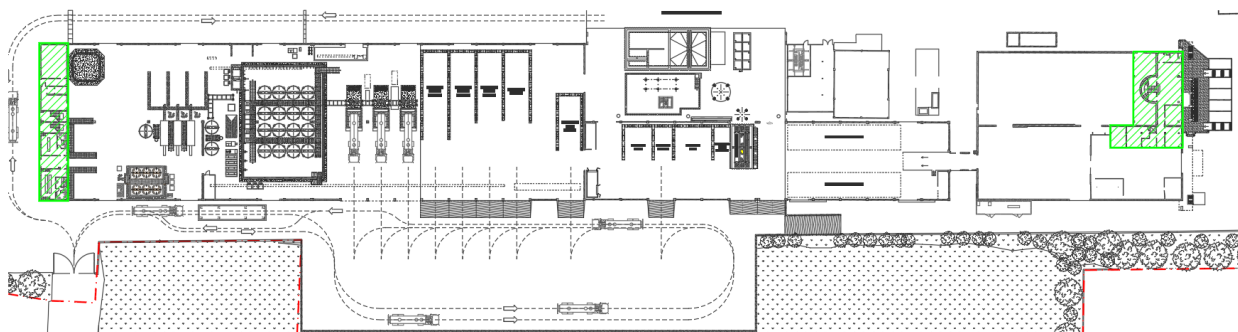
Estratto di planimetria generale con indicazione delle aree componenti il compartimento uffici
